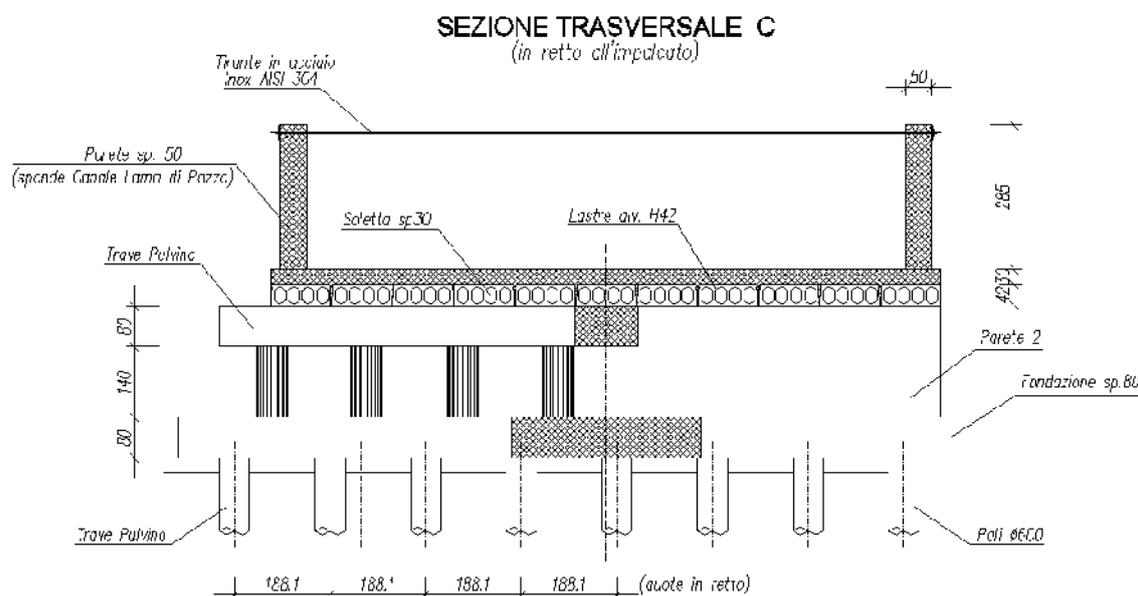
Fig. D – Sezione Trasversale dell'Opera (in retto all'impalcato)
